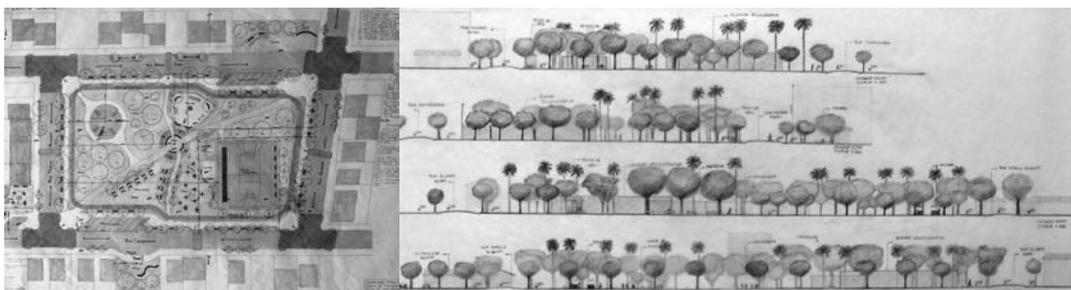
Etapa Estudo Preliminar: planta baixa e fachadas da solução proposta
